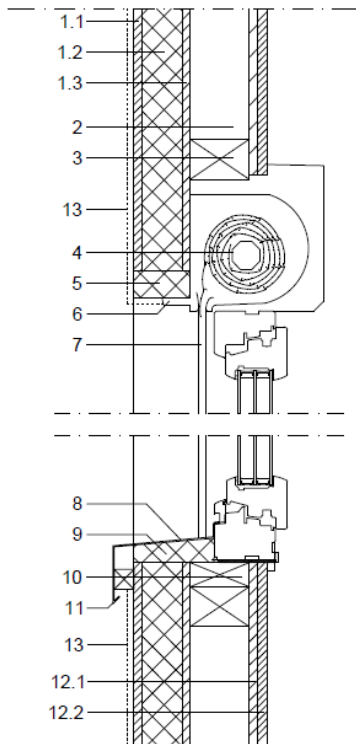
Encuentro tipo de fachada formada con paneles SATE y Revestimiento interior COAT con carpintería. Sección transversal horizontal y vertical.
